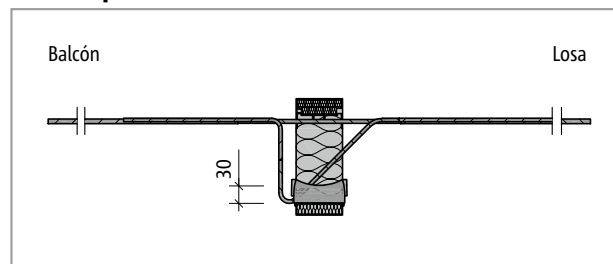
Schöck Isokorb® T tipo K-M5 hasta M6: Sección del producto
